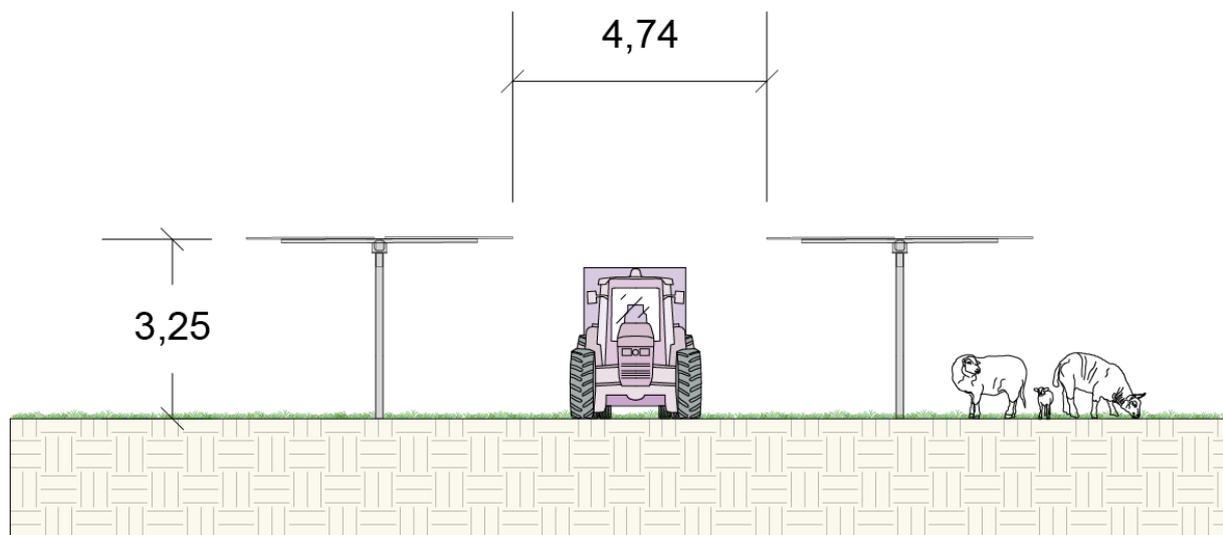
SISTEMA AGRIVOLTAICO ELEVATO, SEZIONE TIPOLOGICA DELL'IMPIANTO
